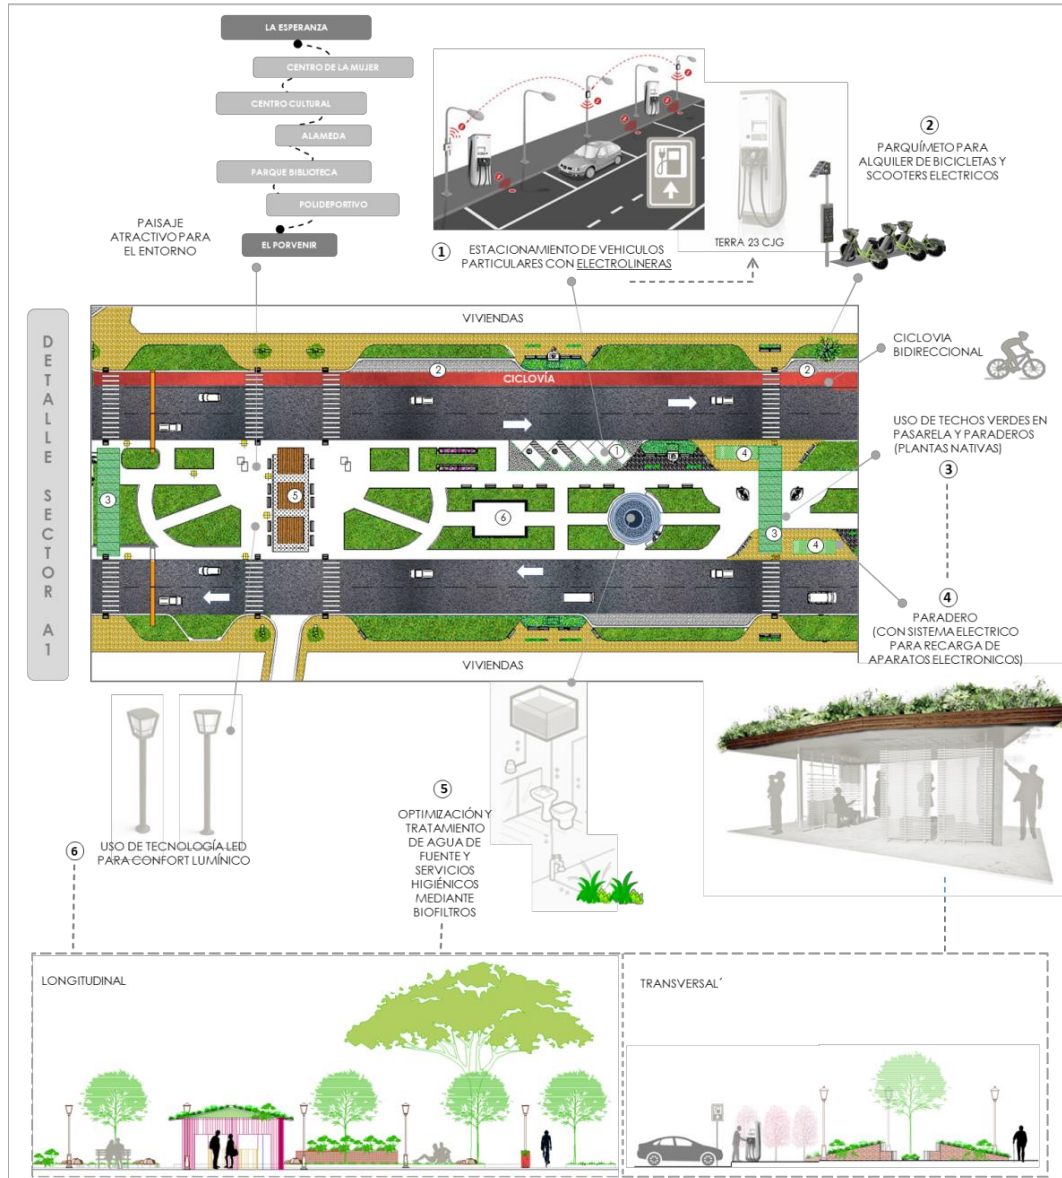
Propuesta de corredor ecológico, planta y cortes del Sector A-1. Elaboración propia.
